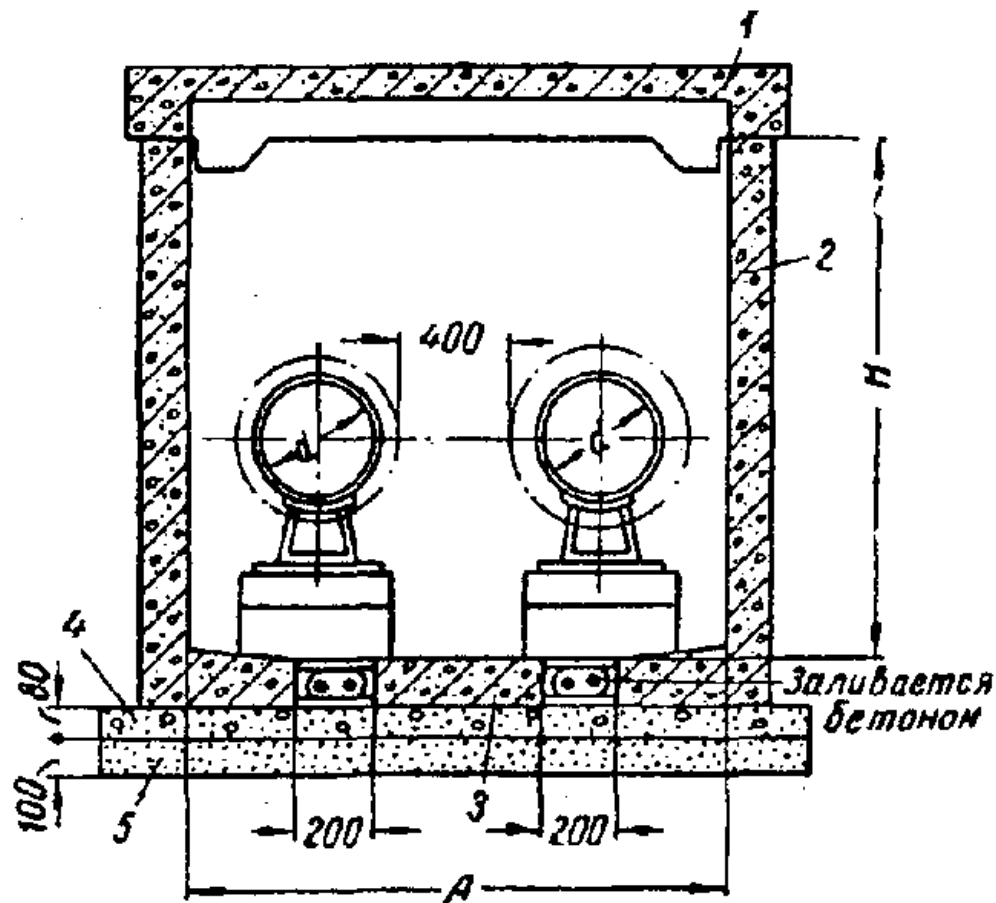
Полупроходной канал из сборных железобетонных блоков:
